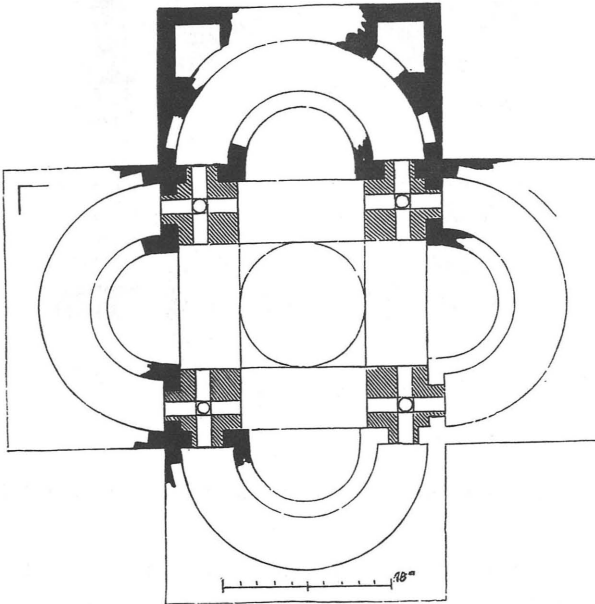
Etapas de la construcción de Santa Sofía de Andrinópolis
